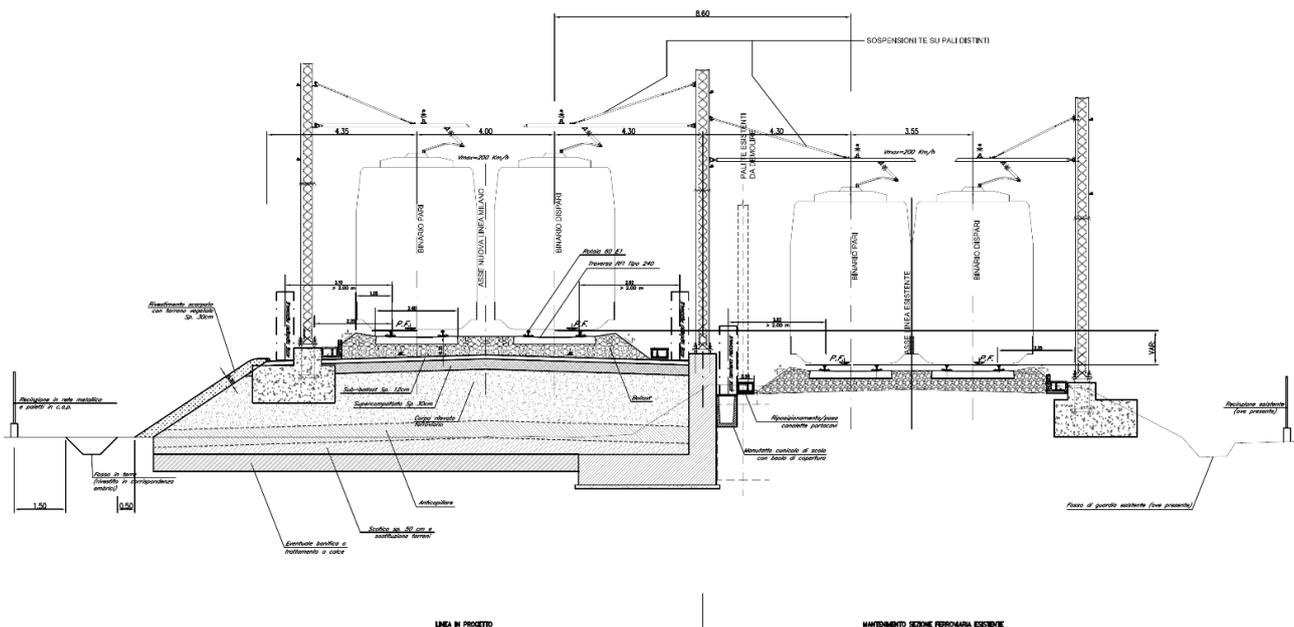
Sezione tipo in rilevato con quadruplicamento in quota sopraelevata rispetto all'attuale linea.
